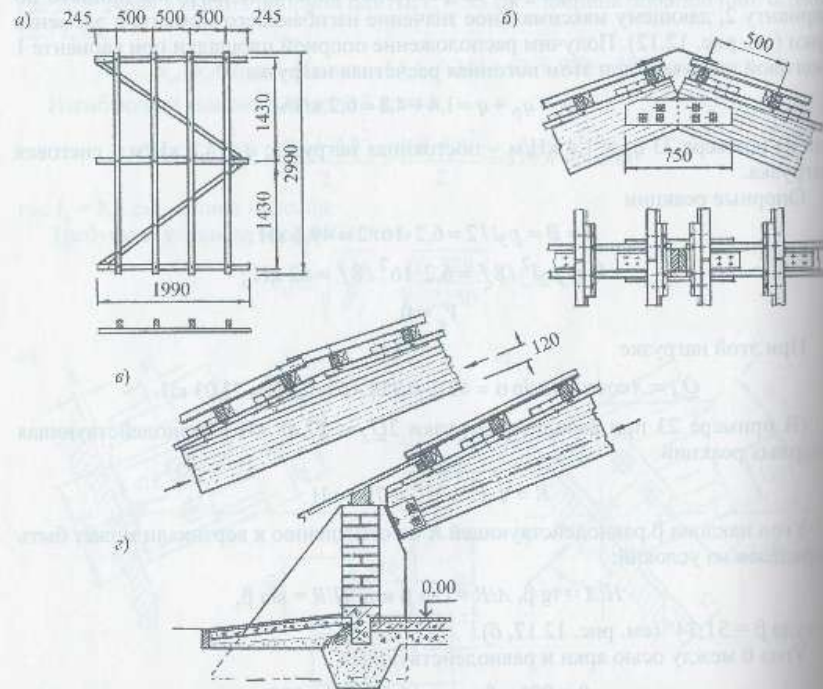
Конструктивные решения покрытия по аркам из прямолинейных элементов: а – конструкция щита и его крепление к элементам арки; б – конструкция конькового узла; в – зона переноса кровельного ограждения; г – конструкция карнизного узла
